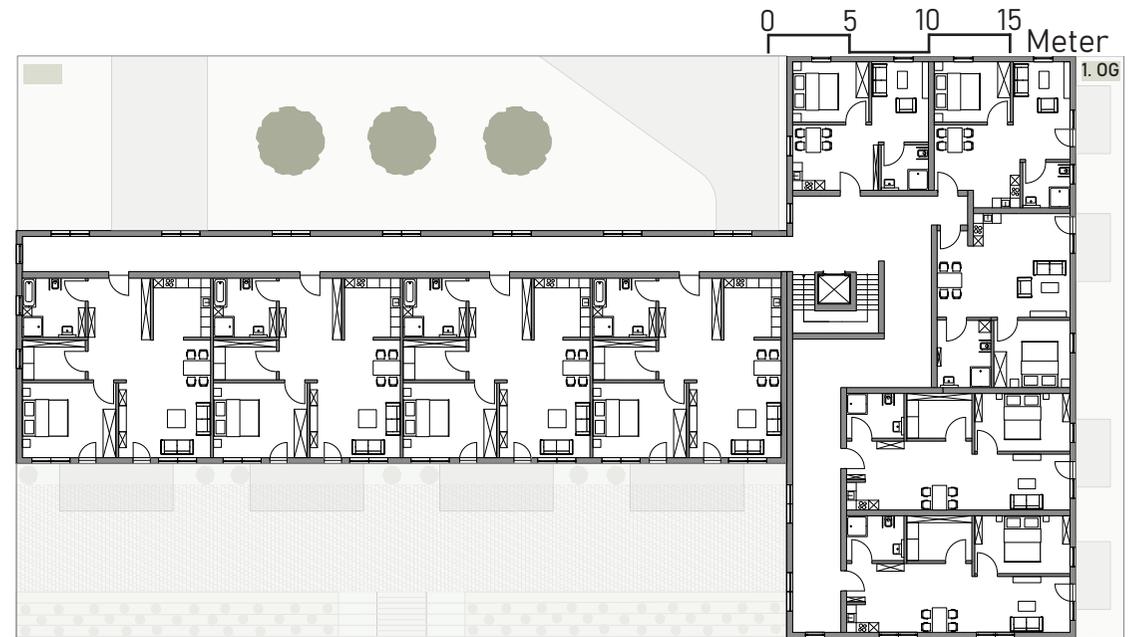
Grundriss 1. OG (V1 Stelzenbau)
